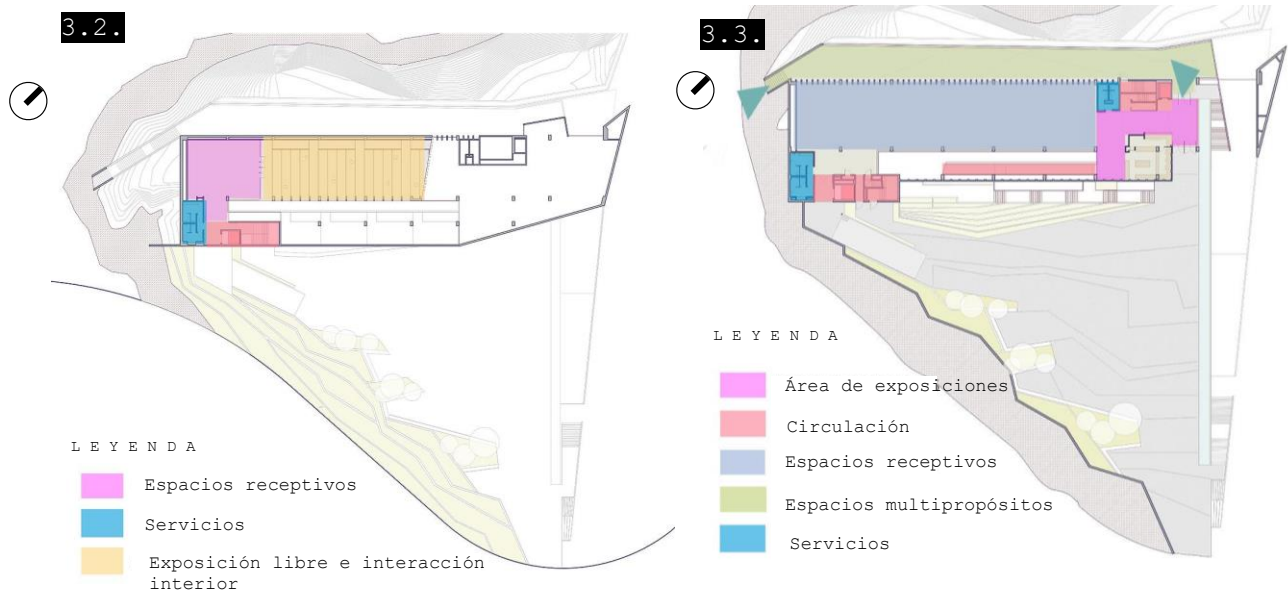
Entreplanta. (redfundamentos, 2014) Edición: Elaboración propia.
